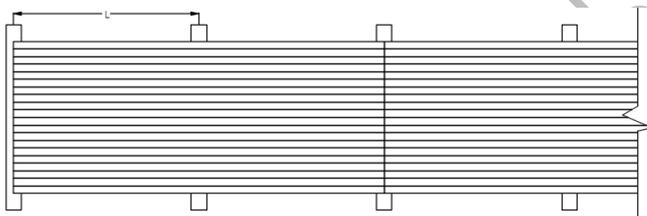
MLC tipo 2, laminaciones continuas con más de un apoyo
